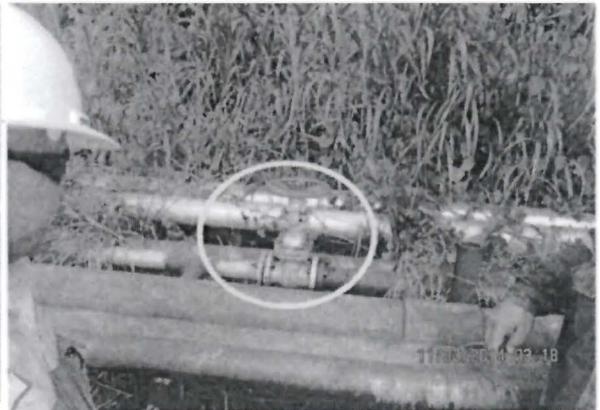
Vista de la válvula de donde ocurrió el derrame y se reparó la avería cambiando la empaquetadura.
